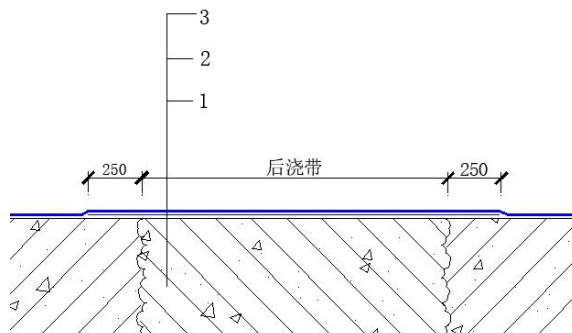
顶板及侧墙后浇带防水构造示意图
